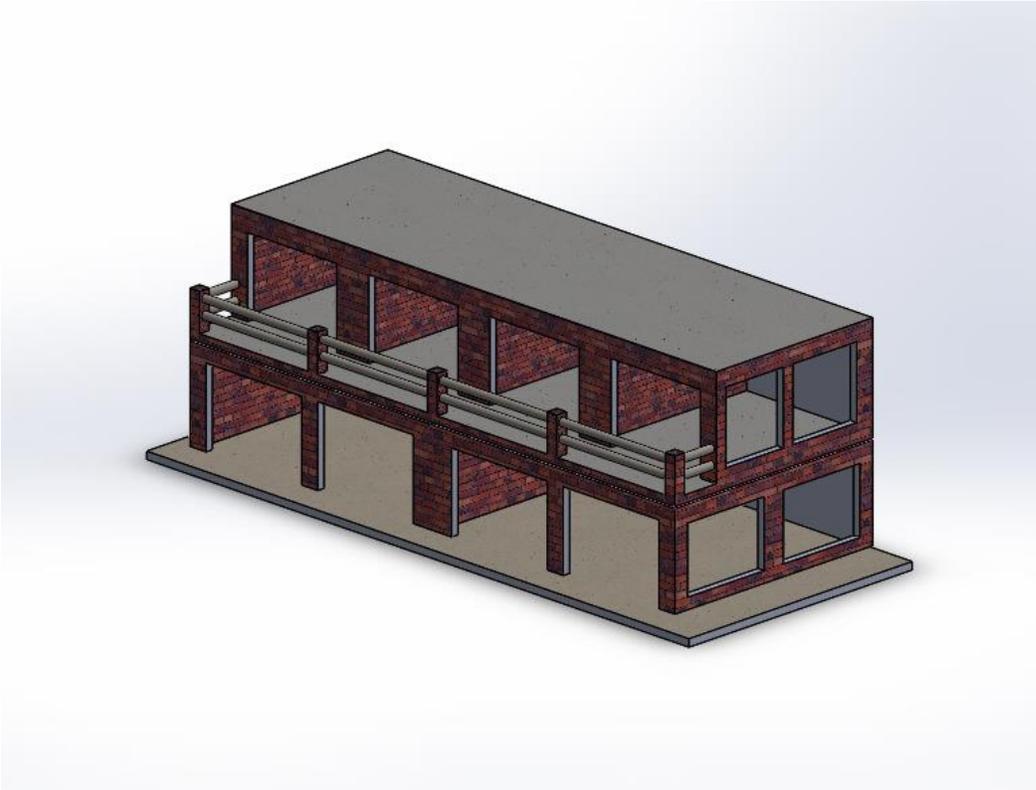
Vista frontal del centro de manufactura aditiva. Elaboración propia.
